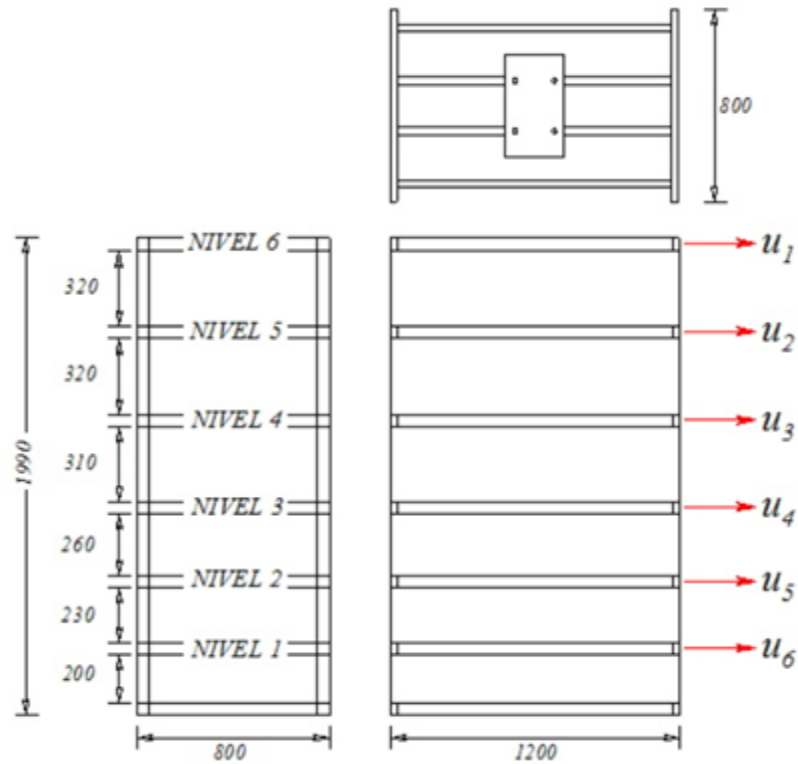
Vista en planta y elevación de la estructura. Señala dimensiones en milímetros y grados de libertad de ésta. Esquema modificado del realizado por Rozas (2009).
